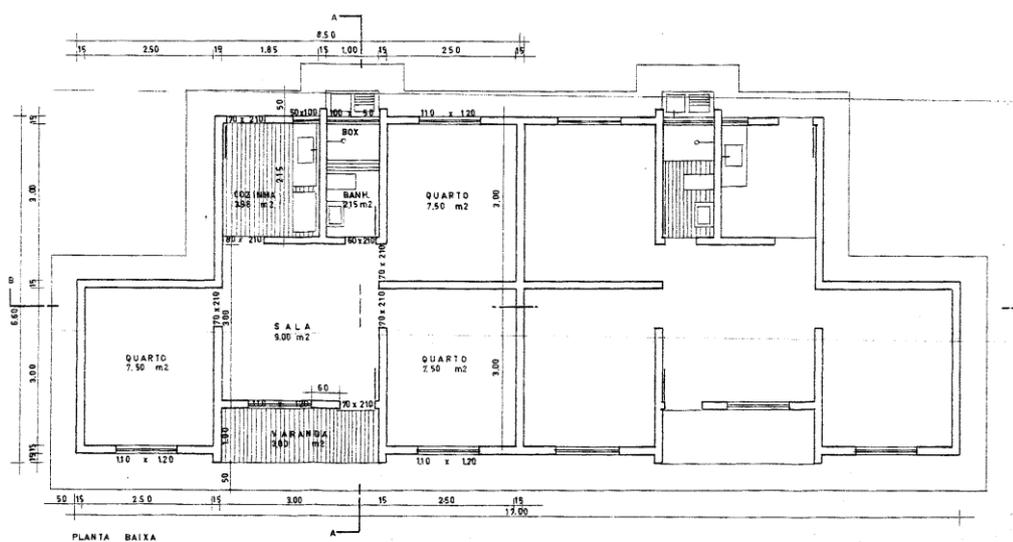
Planta baixa casa tipo B. (Fonte: Cohab).
